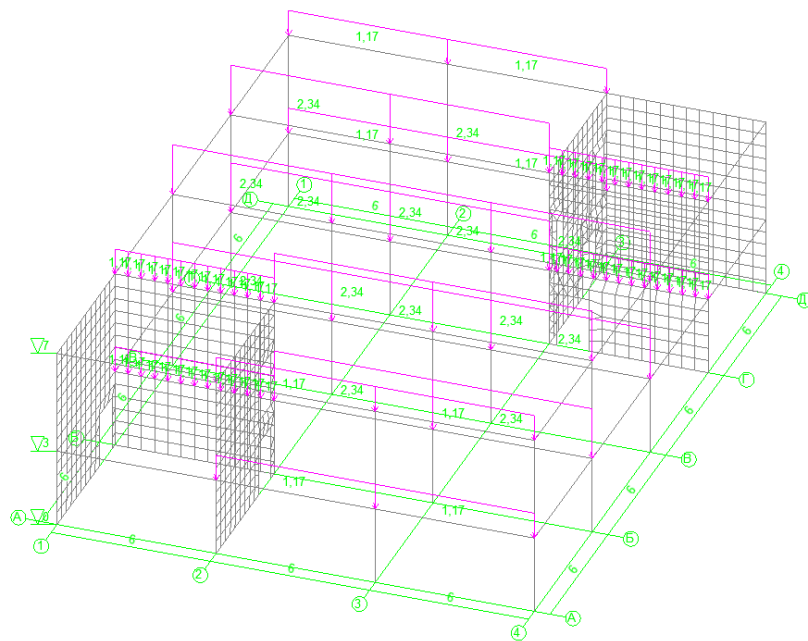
Расчетная модель, нагруженная полезной нагрузкой.
